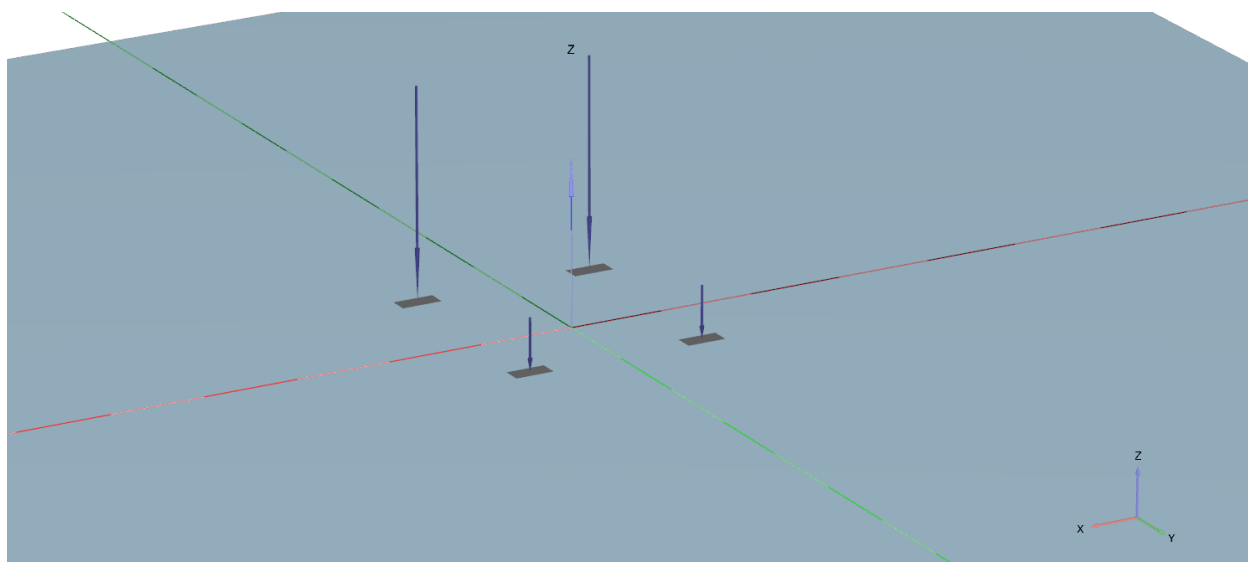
Расчетная схема приложения нагрузки от экскаватора Hidromek 102B на грунт
